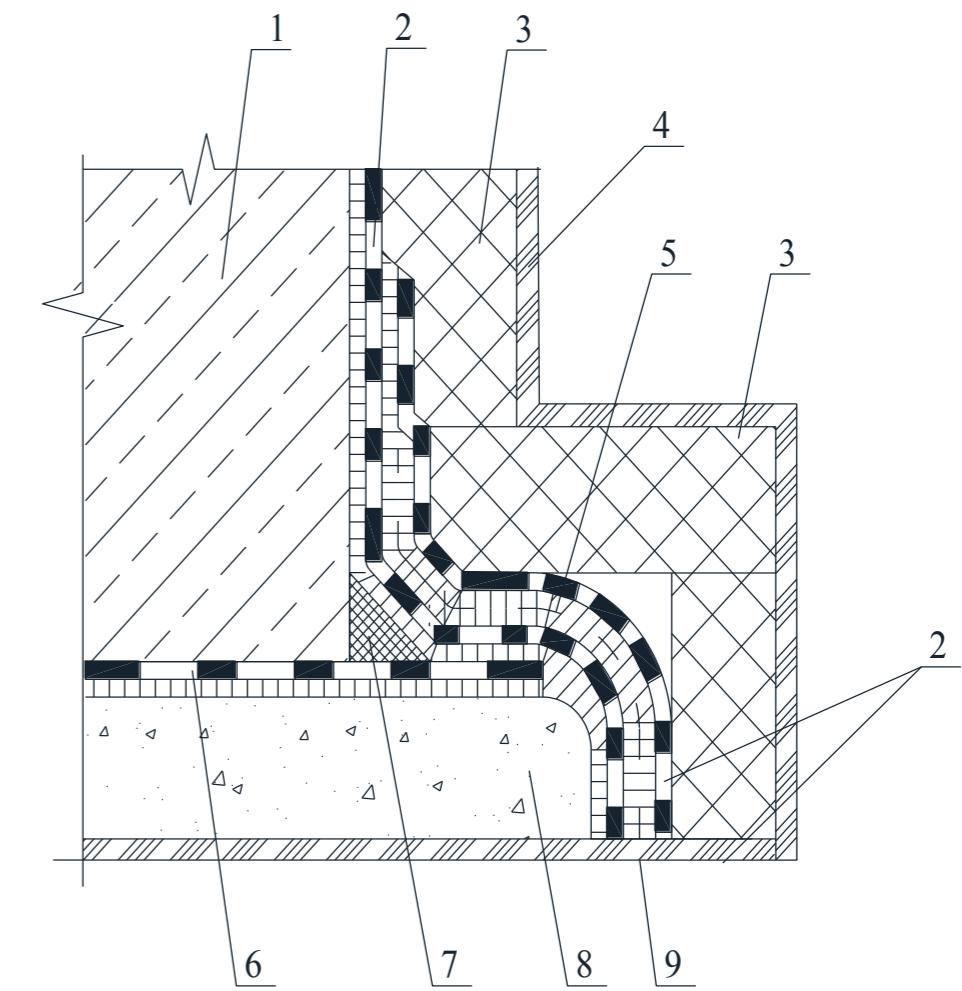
Узел Б.1 Сопряжение места фундаментной плиты/бетонная подготовка подземных конструкций градирни
